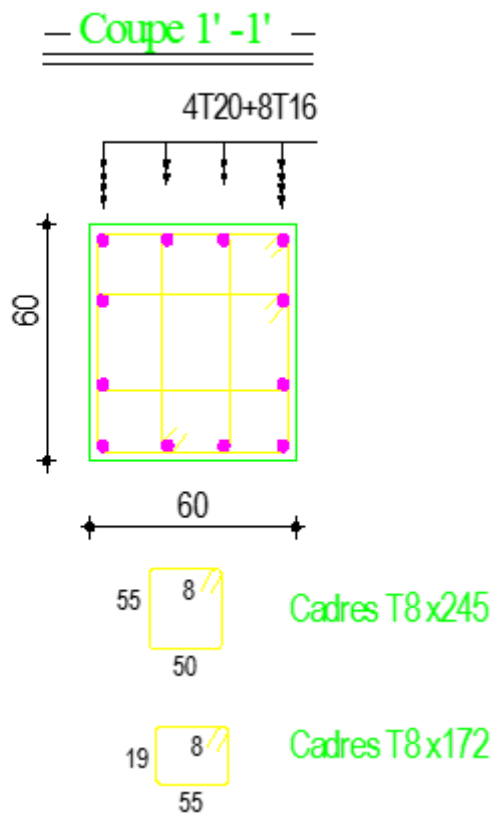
Exemple de ferrailage d'un poteau (60×60)
